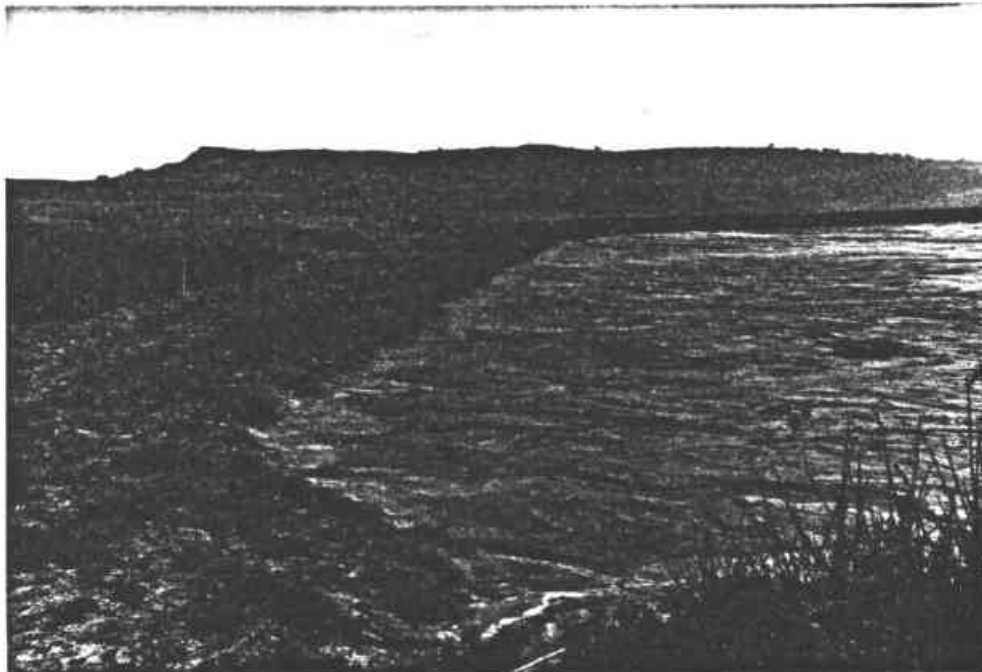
Bassin de décantation ("plage") n° 4. Plantations sur le sommet de la digue (essai vers l'intérieur de la digue après ajout de terre).
